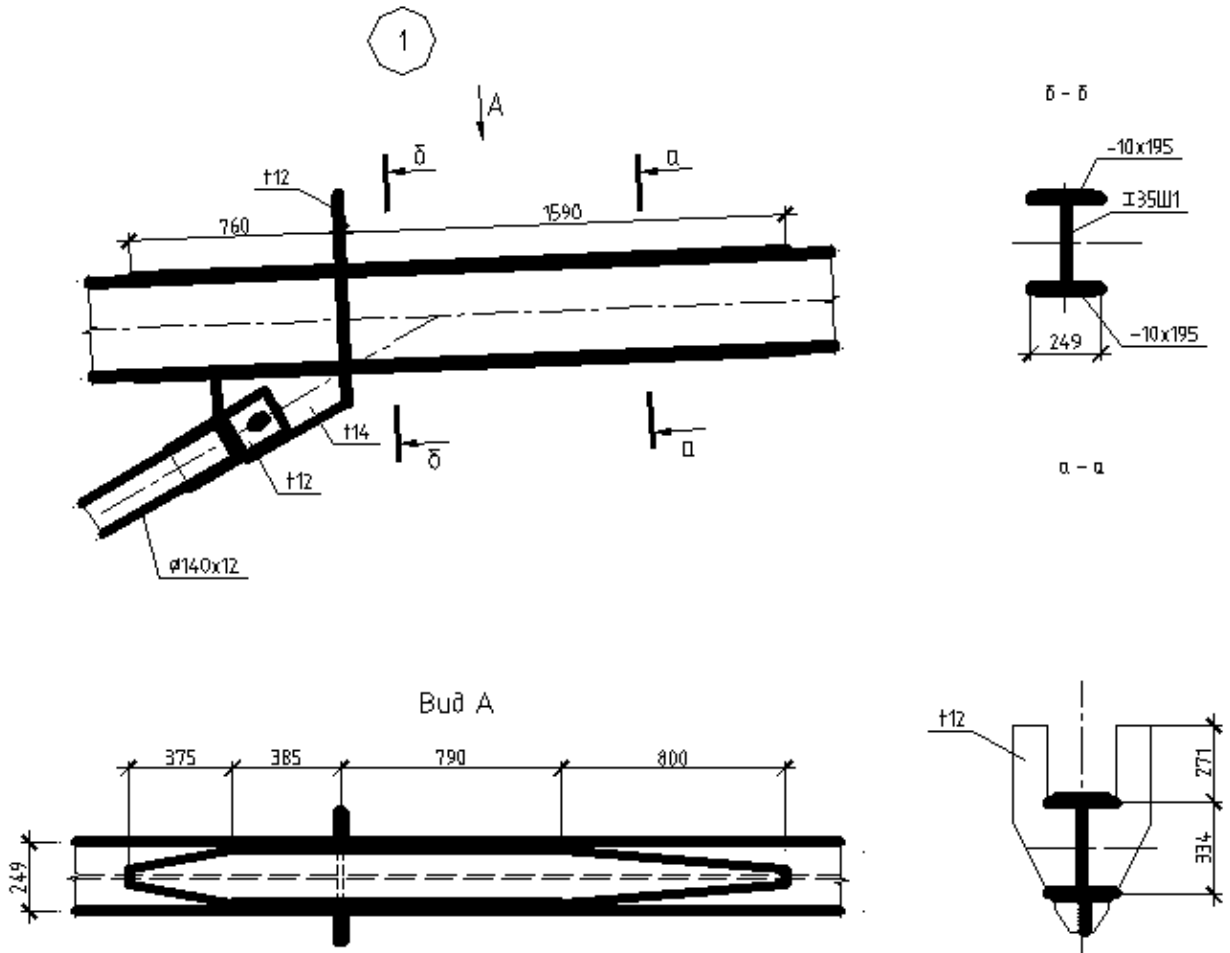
Узел опирания балки, усиленной накладками, на подкос в пролете 18 м
